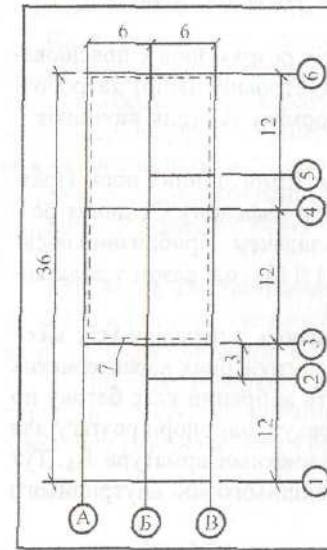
План осей фундаментів цегляного будинку: А-В – поздовжні (літерні) осі; 1-6 – поперечні (цифрові) осі; 7 – контур підвалу
